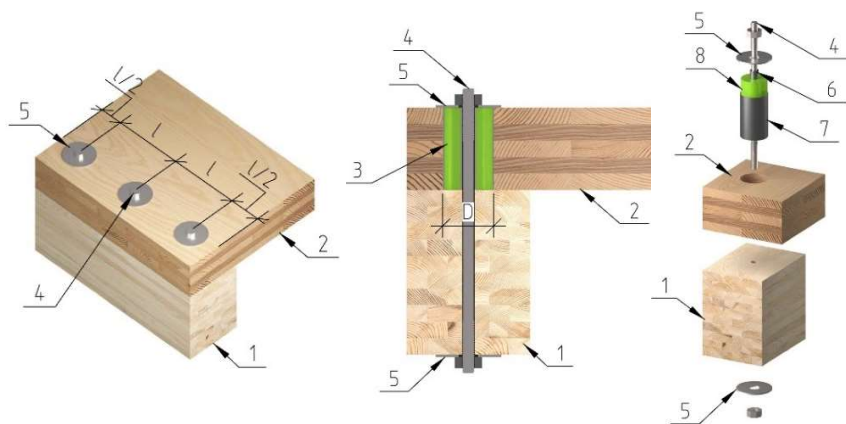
Сейсмостойкий узел сопряжения плиты из ДПК с клееной деревянной балкой перекрытия: 1 – клееная деревянная балка, 2 – ДПК, 3 – вкладыш, 4 – стальной нагель, 5 – стальная шайба, 6 – стальная втулка, 7 – стальная обойма, 8 – упруго-деформируемый материал
